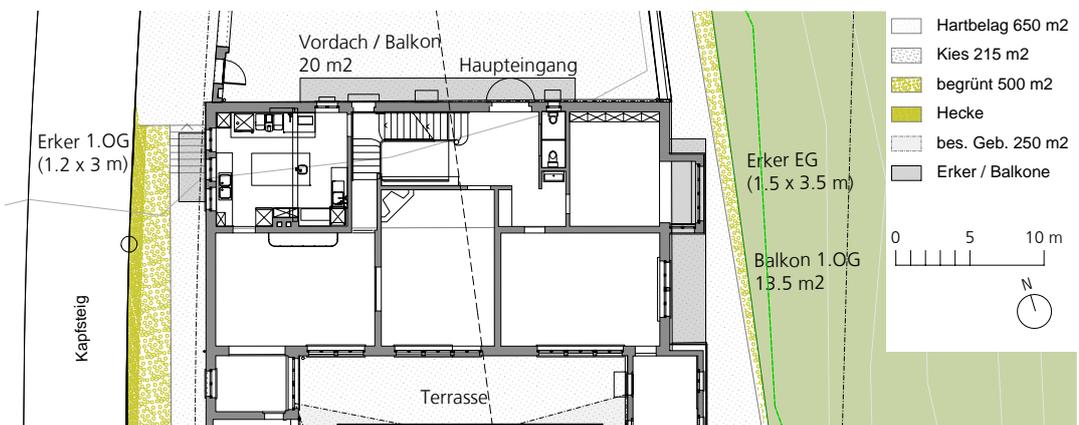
Planausschnitt Ist-Zustand (EG Grundriss) des Bestands mit Erkern und Balkonen
